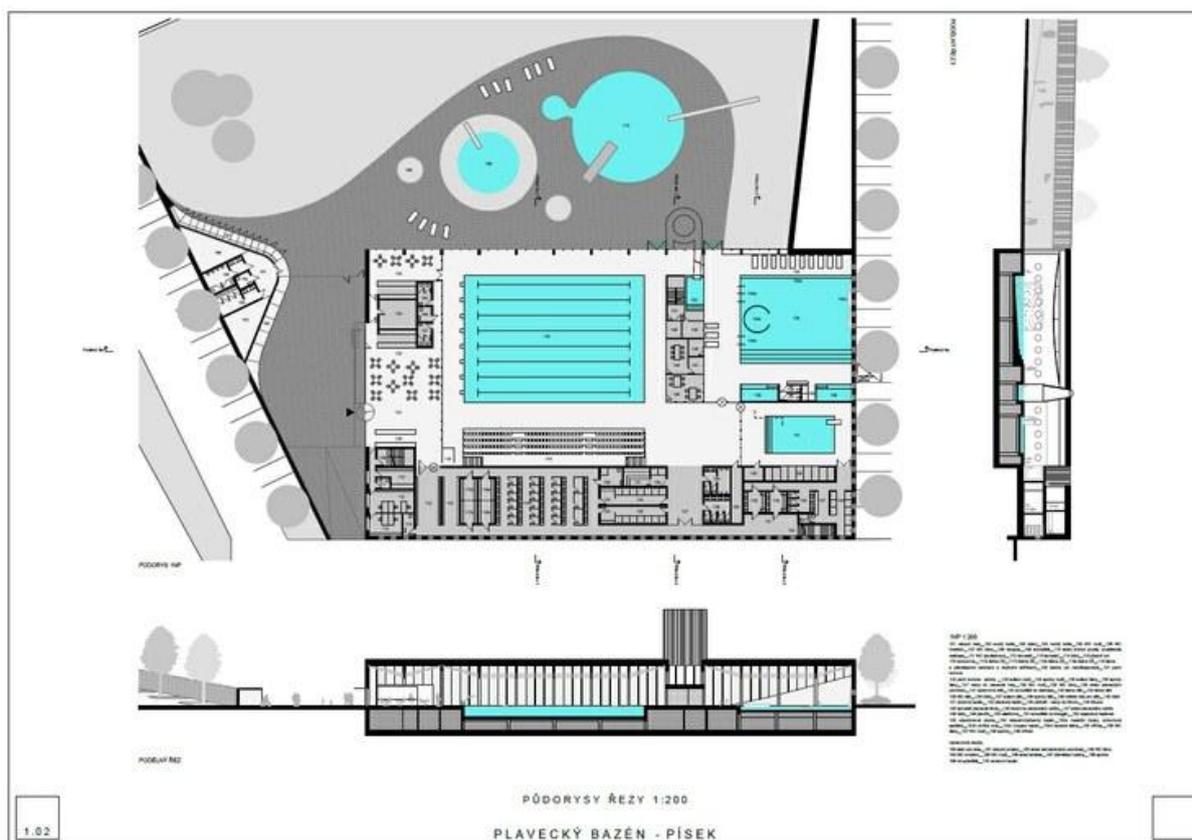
Písek – plavecký bazén (zdroj: www.google.com)
